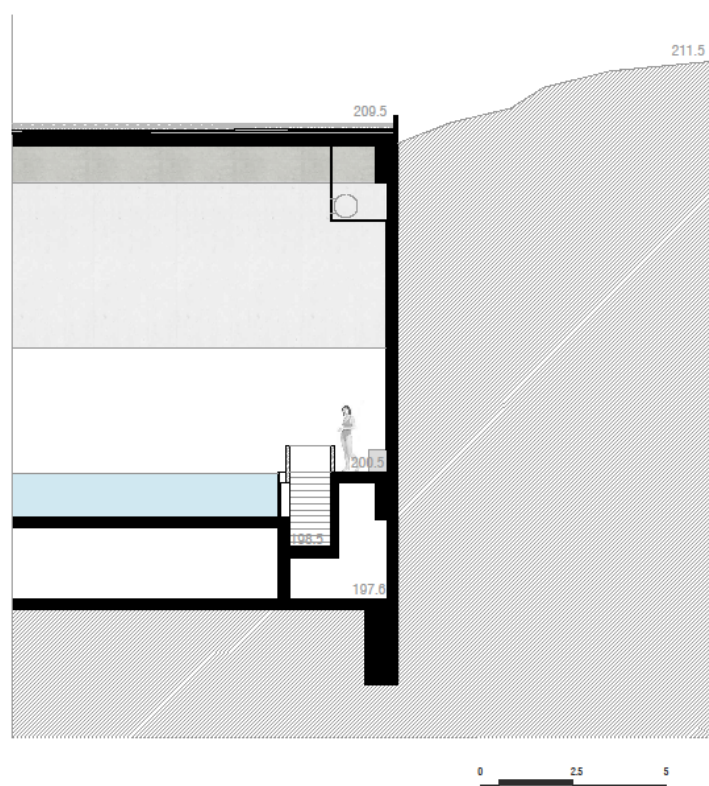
Proposta: Corte Transversal Piscinas, Fonte: Autor
